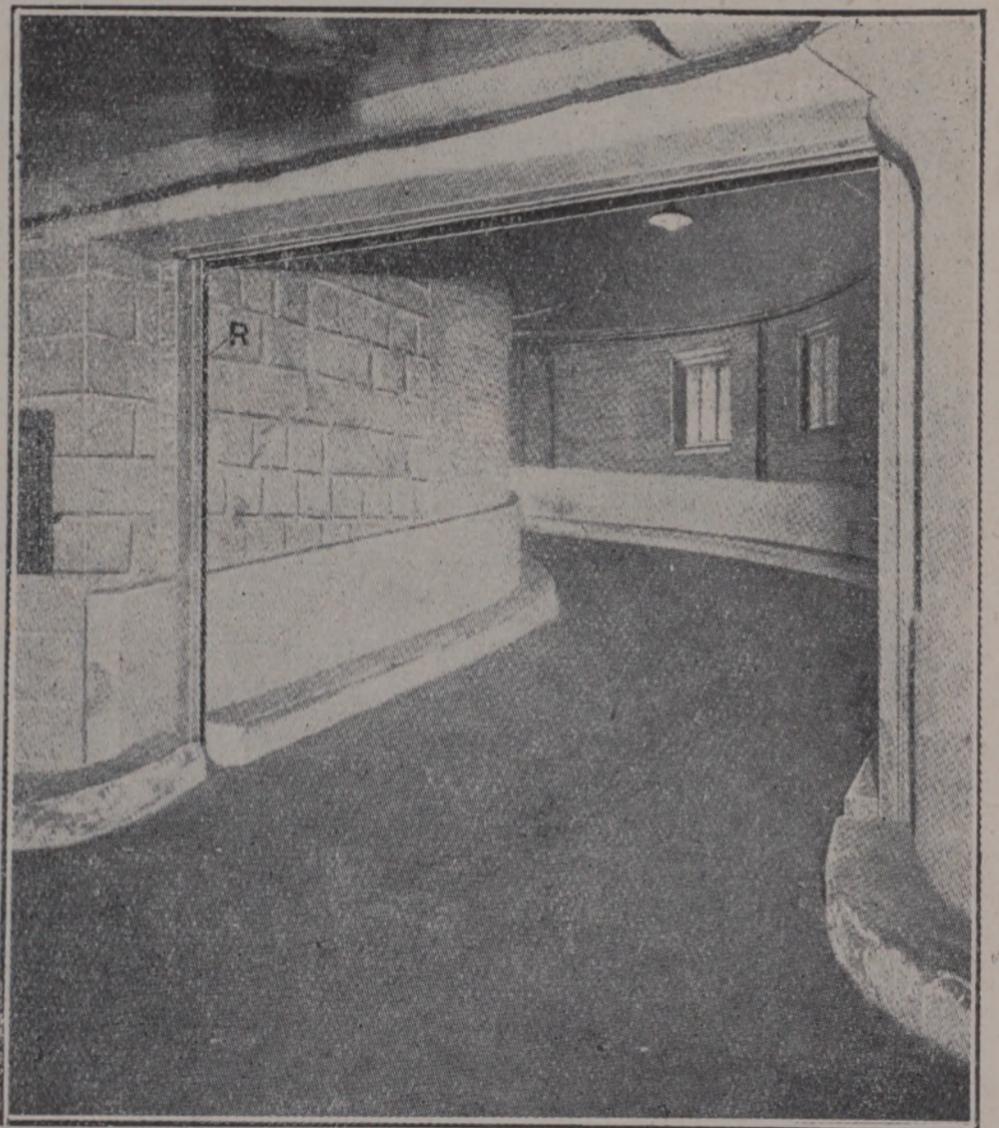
Fig. VII. — Le départ de la rampe du garage La Salle, à Chicago. — R, rideau coupe-feu.
